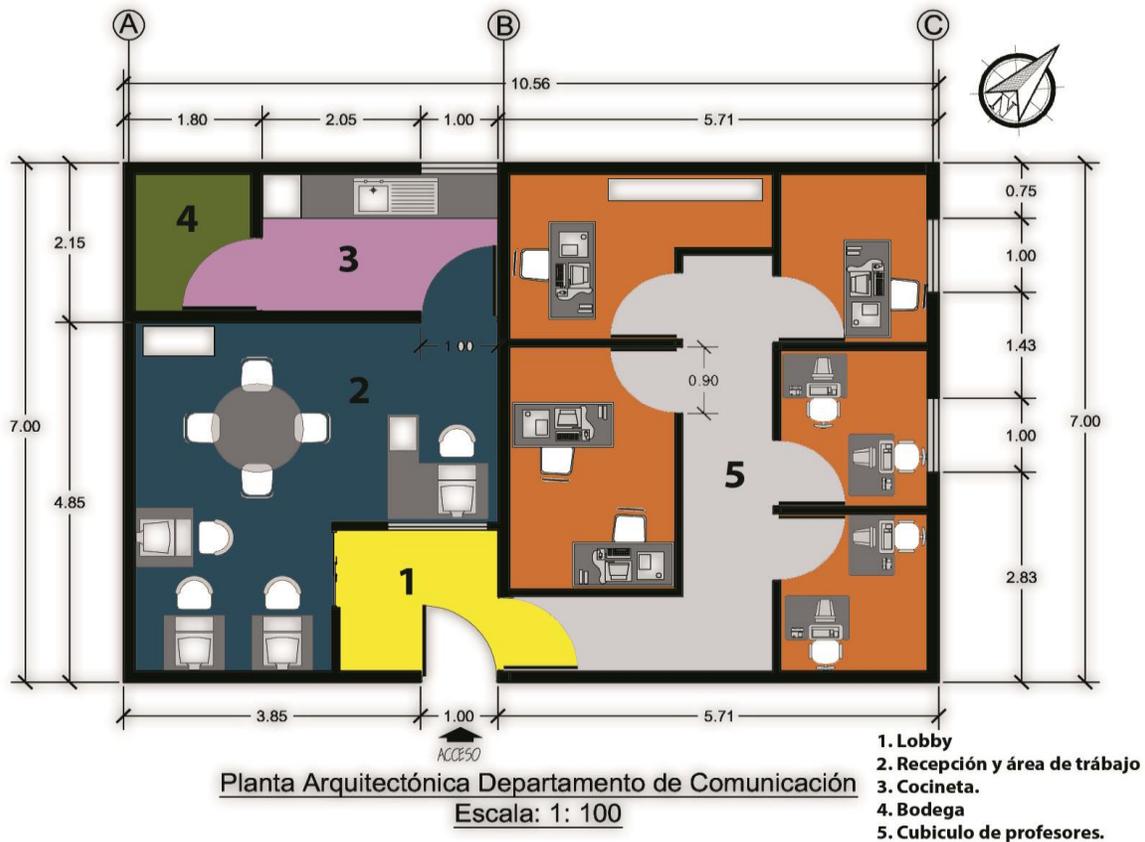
Planta Arquitectónica del Departamento. Fuente
